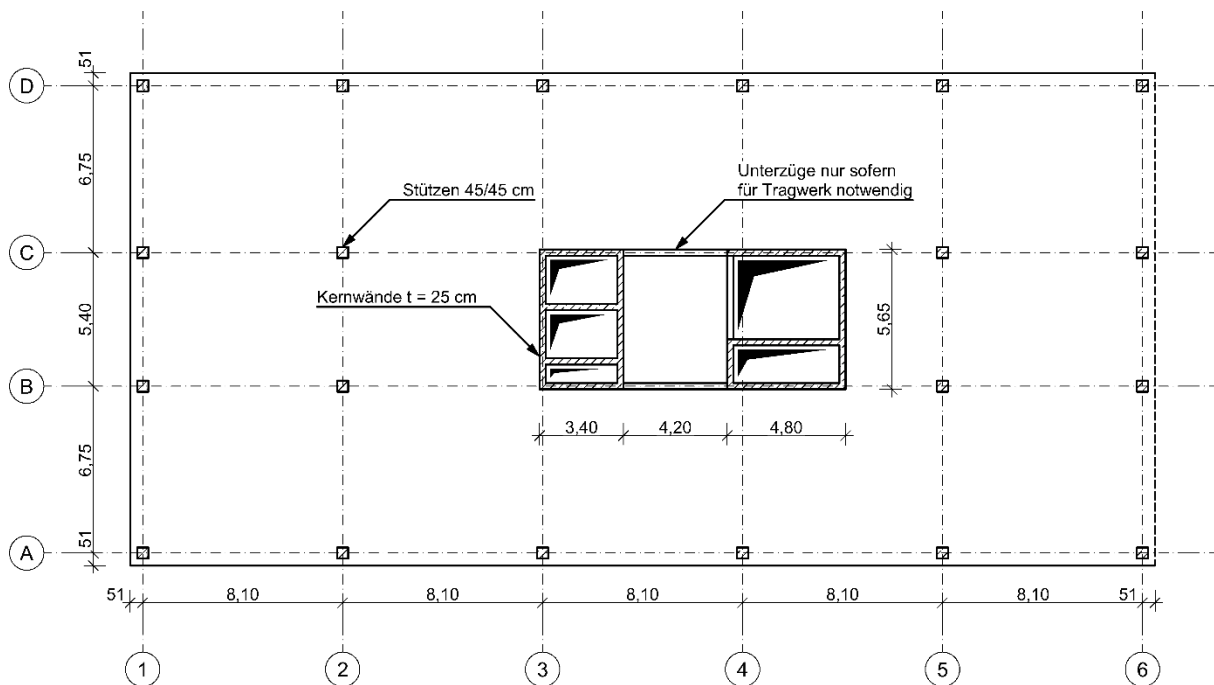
Zugrunde gelegter Grundriss Bürogebäude
